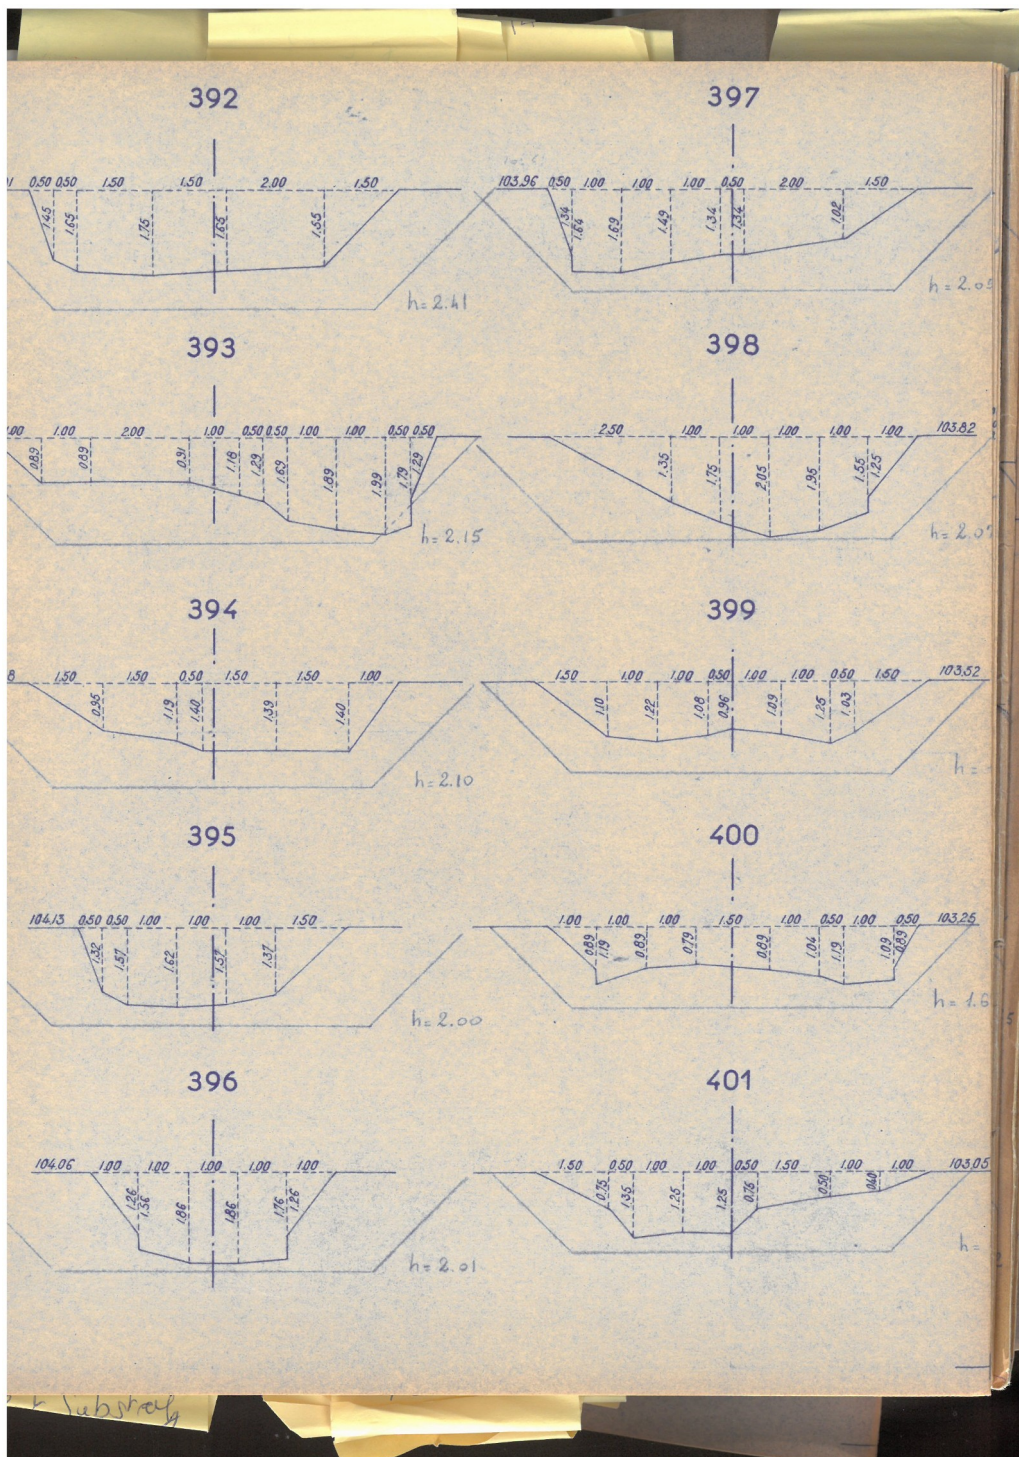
Exemples de profils de la Claise avant et après les travaux de curage sur la zone de travaux à Vendoeuvres
